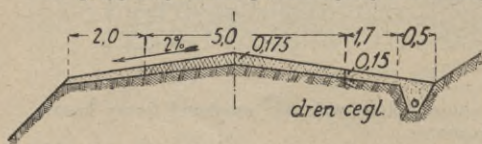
Przekrój amerykańskiej drogi betonowej.
